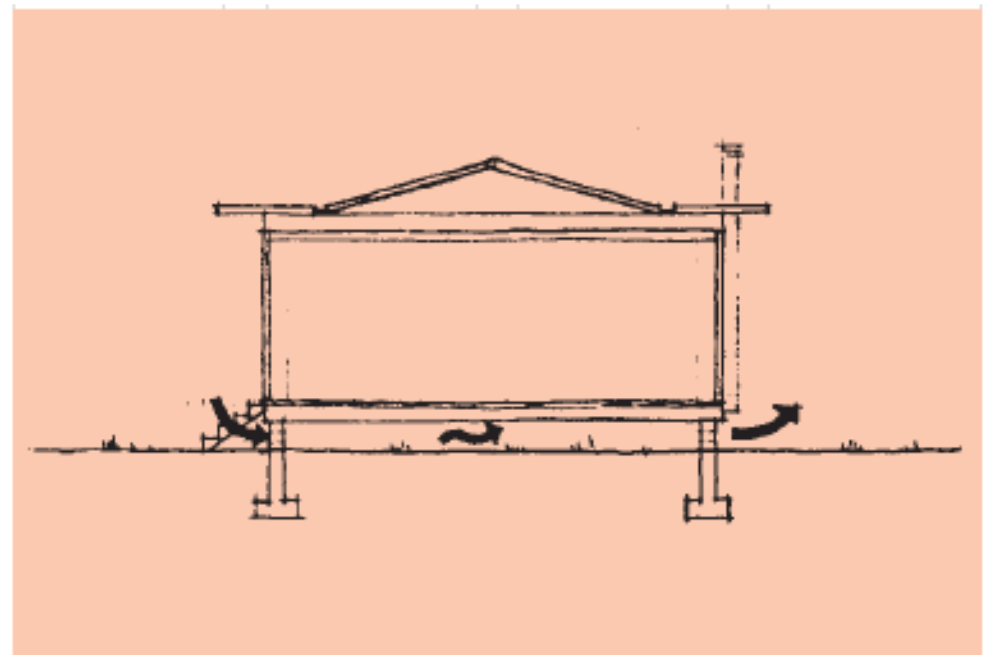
Ventilation de vides sanitaires sous le bâtiment.
